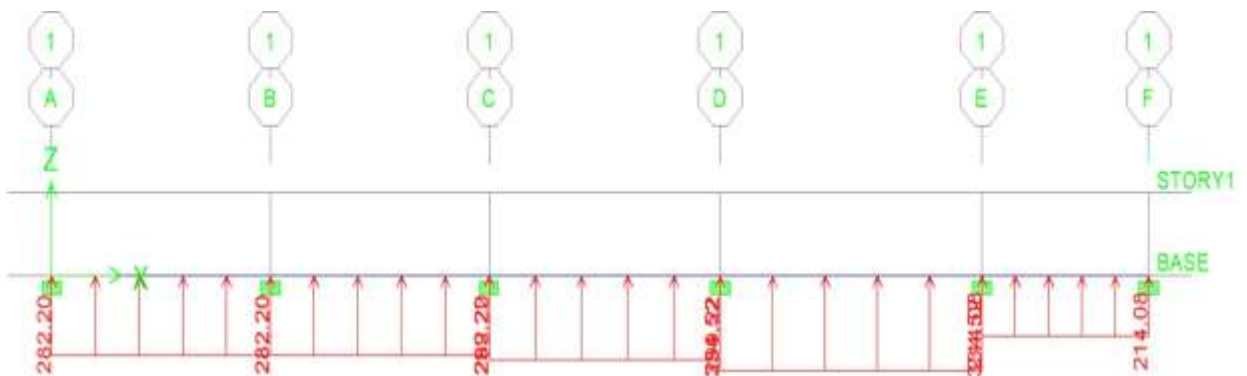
Schéma statique de la nervure ELU (sens transversal)
